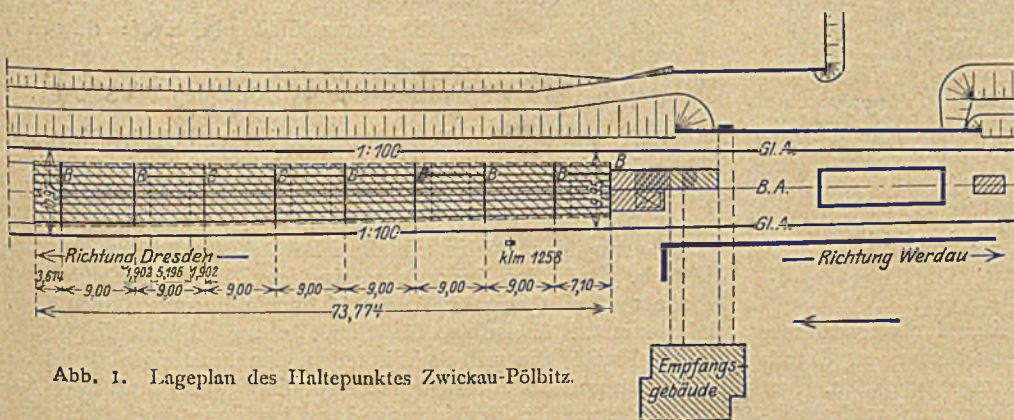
Lageplan des Haltepunktes Zwickau-Pölbitz.
